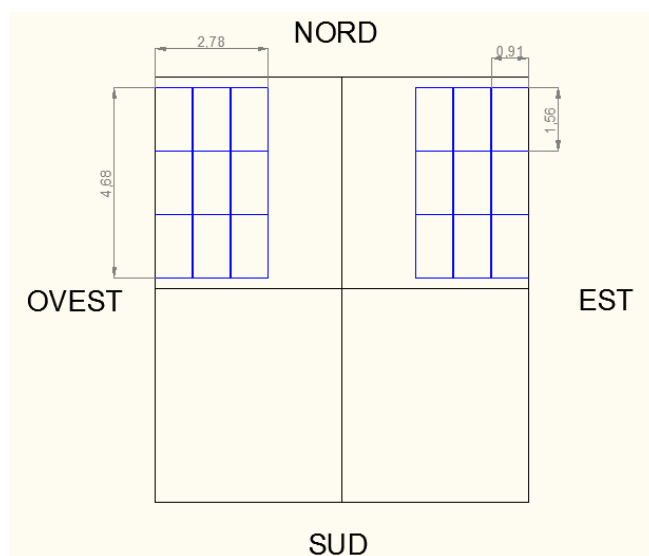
Vista dall'alto dell'impianto fotovoltaico.
